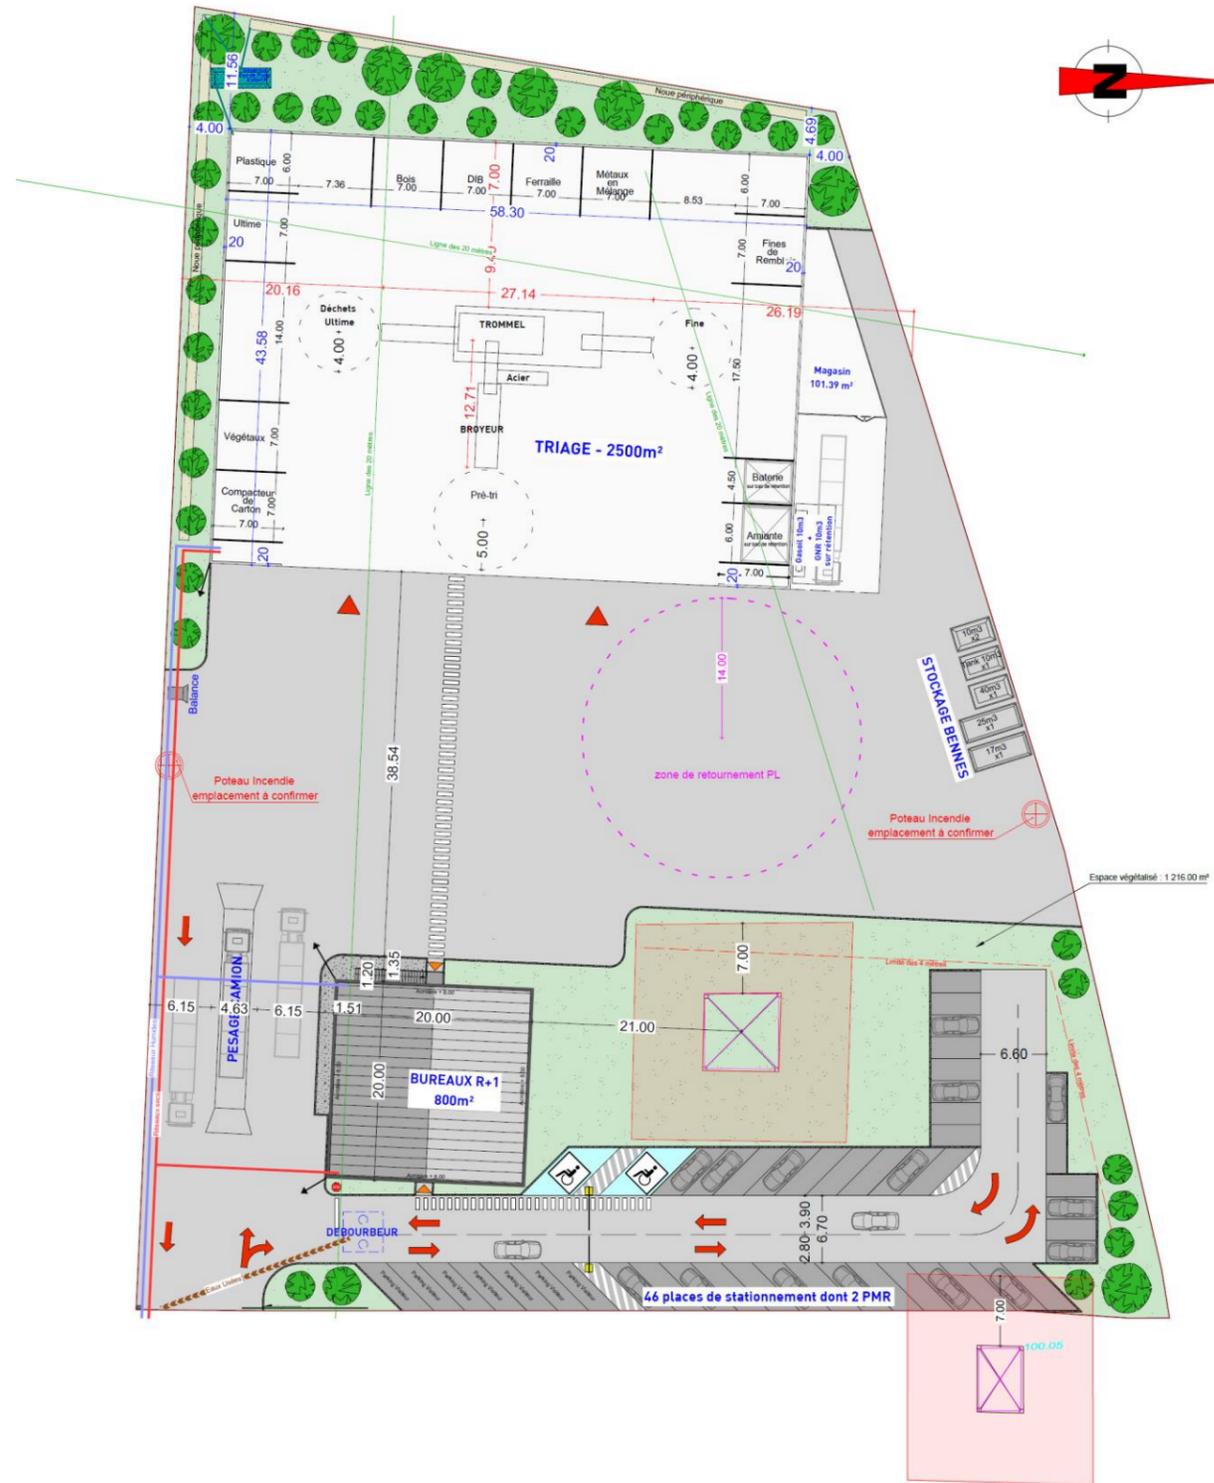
Plan d'aménagement du centre de tri de Jonage
